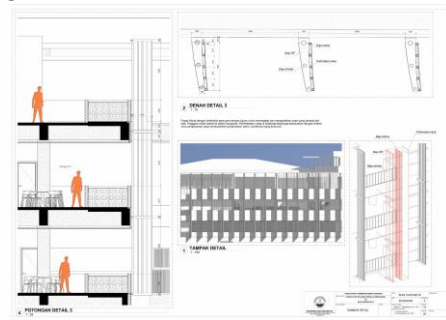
Detail pada gambar 3.3 menunjukkan penerapan salah satu aspek bangunan hijau yaitu dengan void pada area food court yang berfungsi sebagai tempat masuknya penghawaan dan pencahayaan alami ke dalam bangunan.
